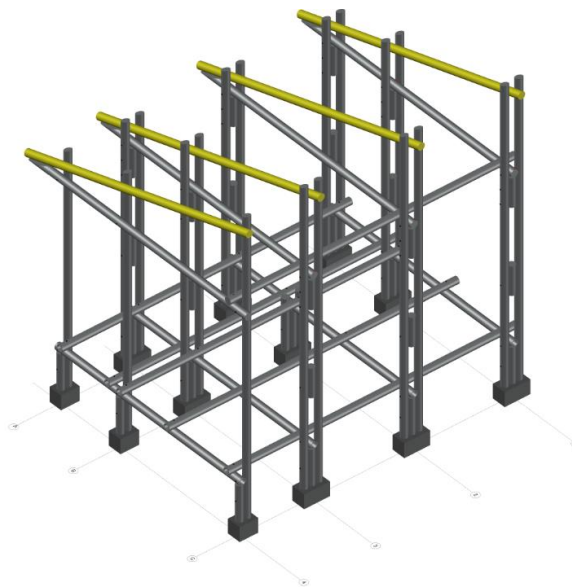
Vigas de Cubierta. Fuente: Elaboración Propia
